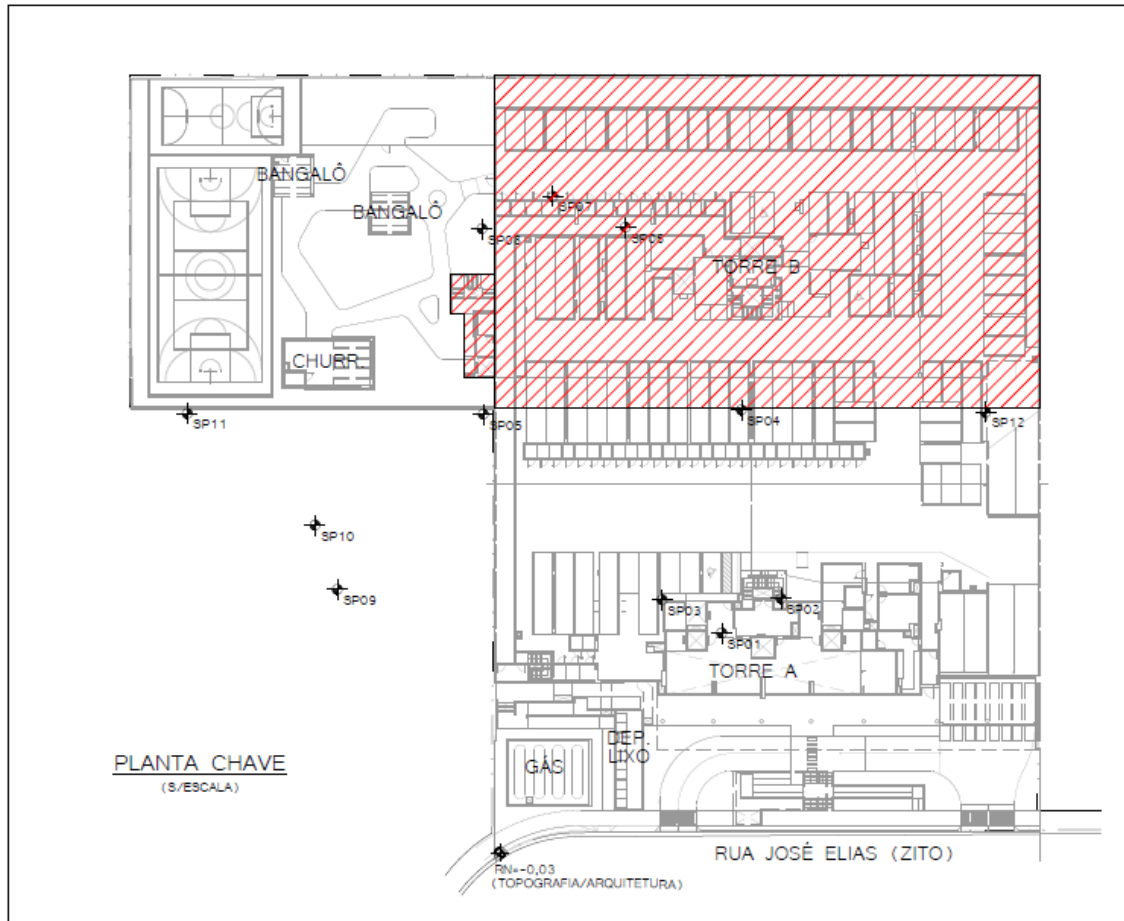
Sobreposição dos furos de sondagem na planta chave do empreendimento (Autora,2022)
